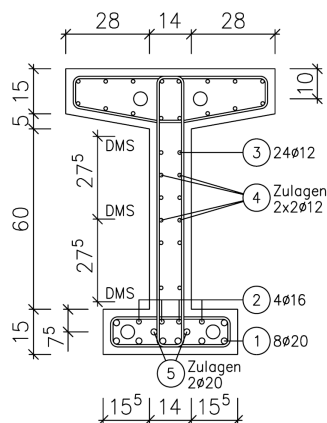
Querschnitt der Träger 1 und 2 mit Längsbewehrung und Querbewehrung und Lage der Dehnmessstreifen (DMS) an den Bügeln.
